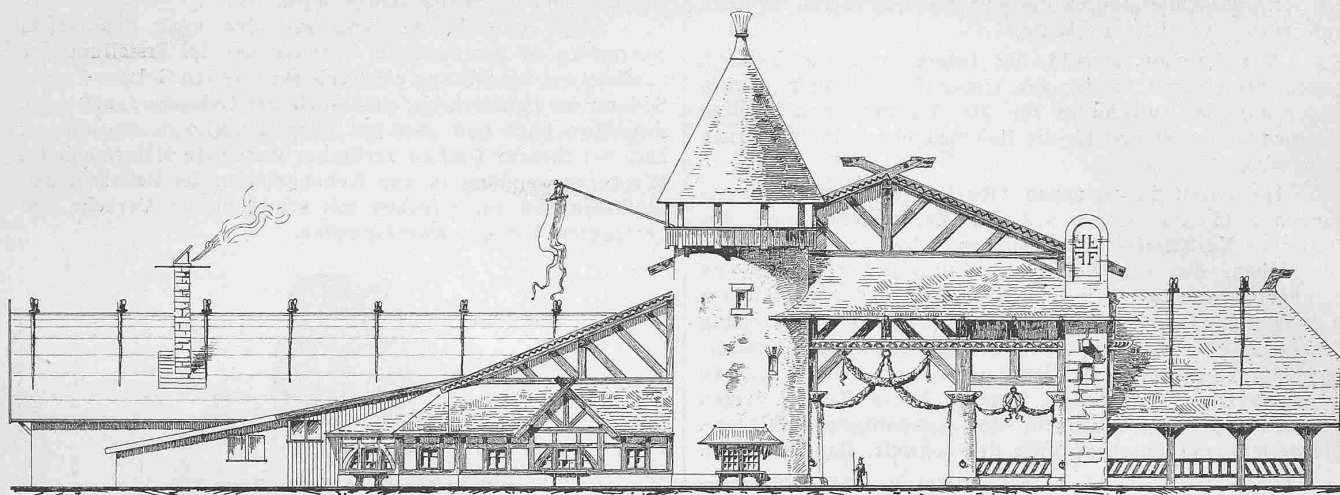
Ansicht der Nordfassade mit dem Haupteingang. — Masstab 1:400.
